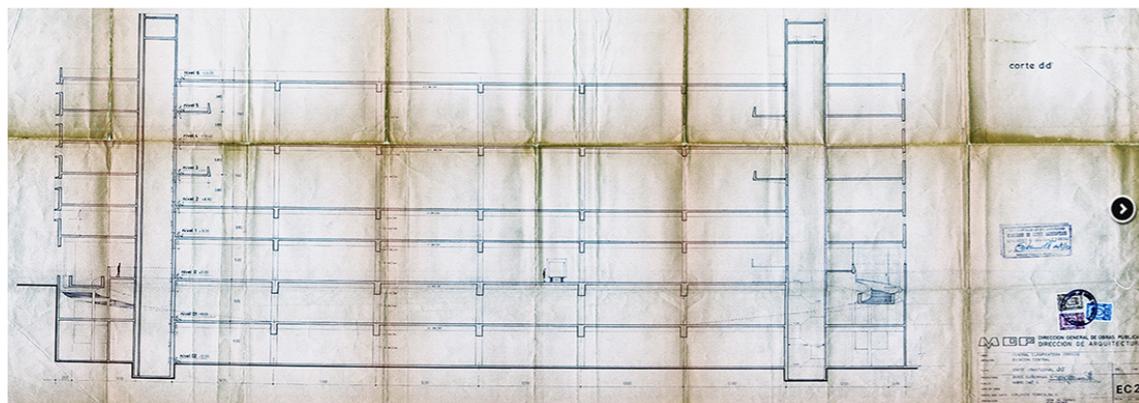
Plano de Corte longitudinal Objeto 2 año 1970.
